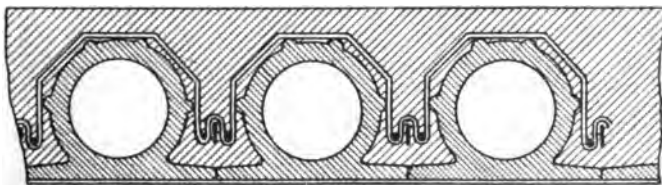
Querschnitt der Hohlton-Eisenbetondecke.
